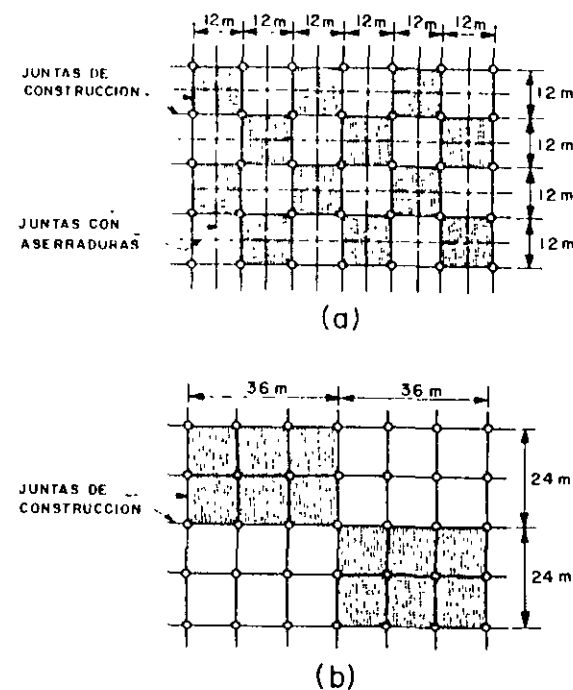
Comparación de los patrones de colocación del hormigón en losas sobre el terreno usando (a) hormigón con cemento portland común y, (b) hormigón con compensador de encogimiento. Este último se puede vaciar en secciones mayores, sin necesidad de efectuar cortes con sierra ni de dejar espacios abiertos alrededor de las columnas.
